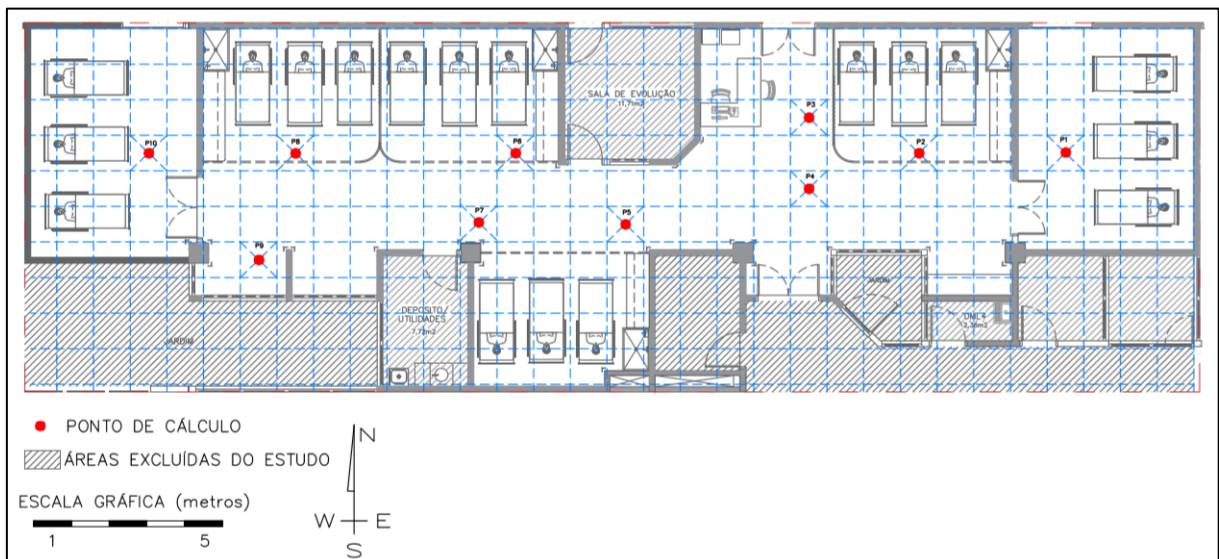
Planta baixa da Sala Vermelha com área de tarefa e localização das fotos
